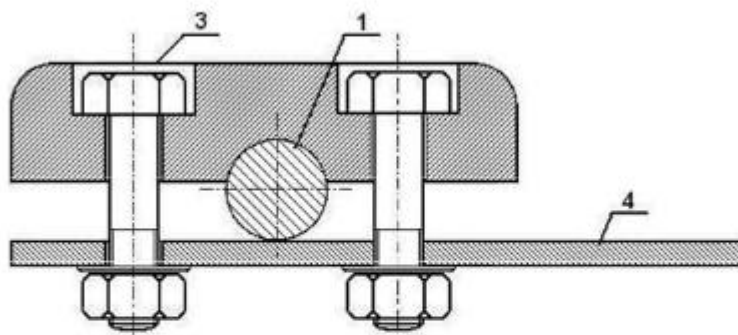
Connessione di un conduttore a nastro ad un ferro d'armatura
